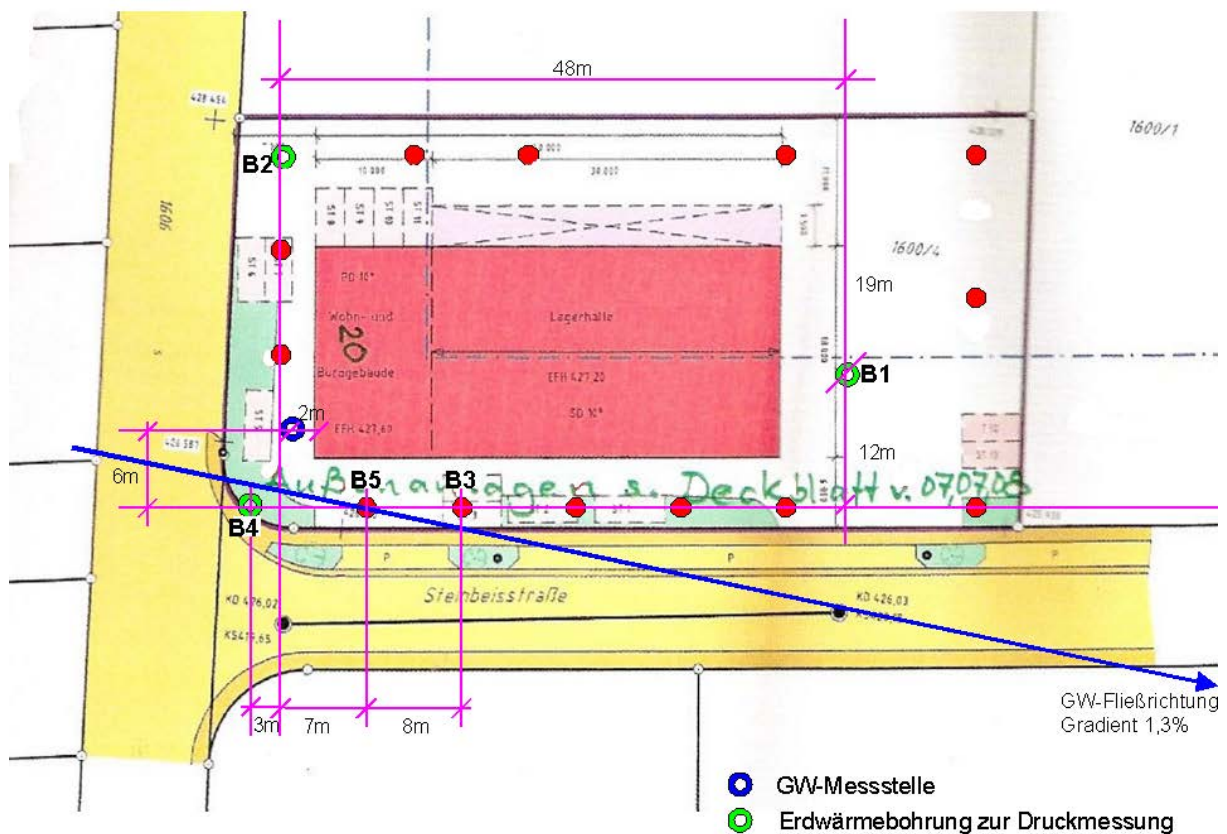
Lageplan der geplanten Erdwärmesonden auf dem Gungl Betriebsgelände
